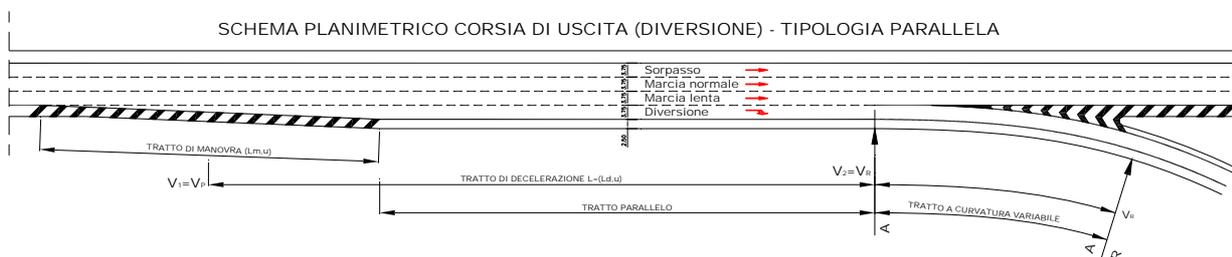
Schema planimetrico corsia di diversione - tipologia parallela
